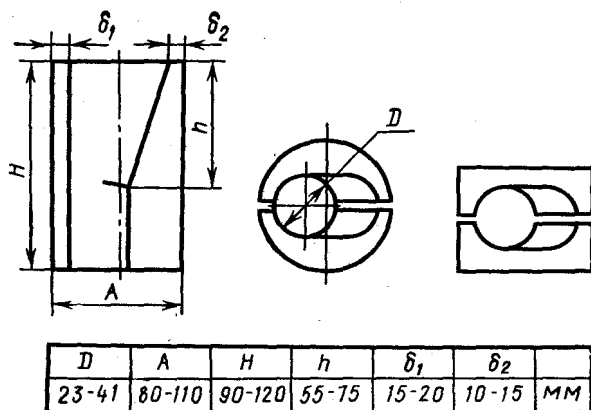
Инвентарные медные формы для сварки стыковых соединений вертикальных стержней диаметром 20 ... 36 мм
